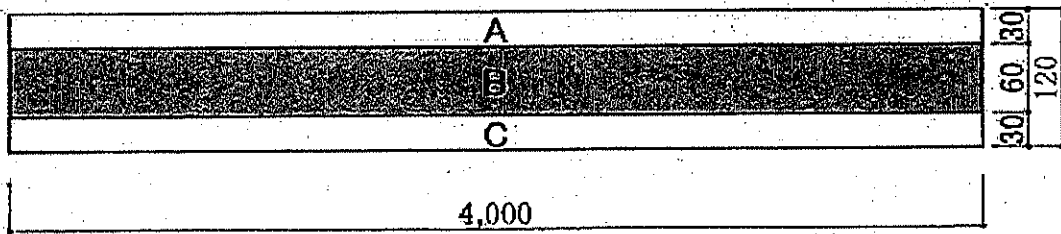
含水率測定位置 (平面図: 外層はヒキ、内層はスギ)
